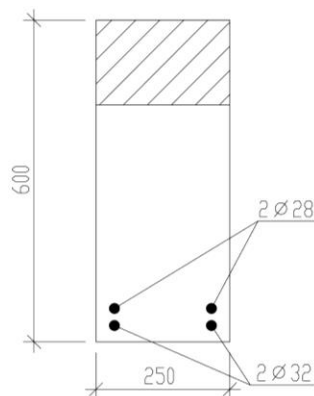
Армирование ригеля в растянутой зоне во 2-ом пролете
